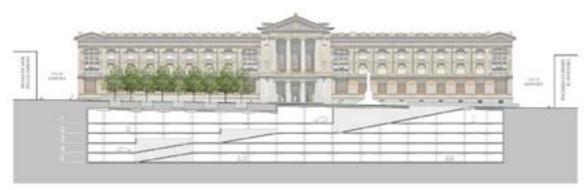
Proyecto Plaza Montt Varas. PLAN Arquitectos.
